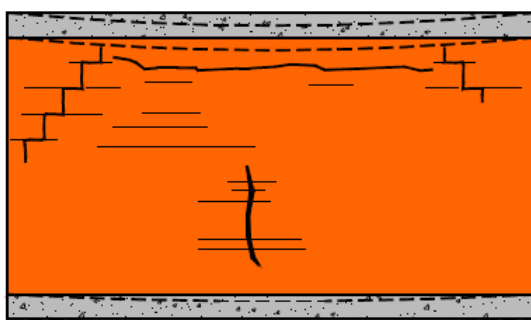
Fissuras provocadas pela deformação do elemento de suporte ser inferior à deformação da viga superior [15]
